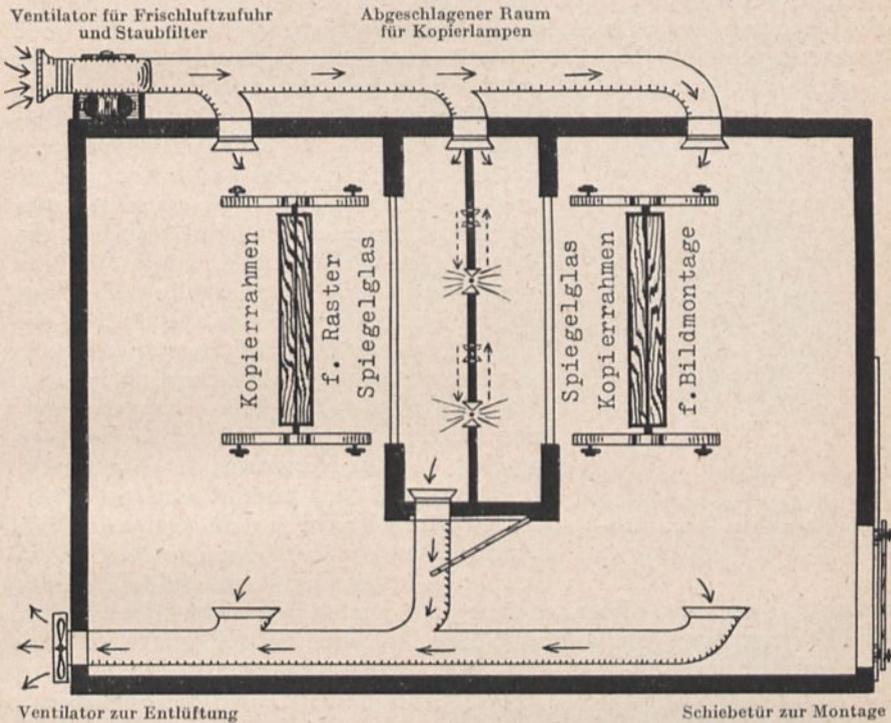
Grundriß eines Kopierraumes mit eingebauten Bogenlampen und zweckmäßiger Be- und Entlüftung
